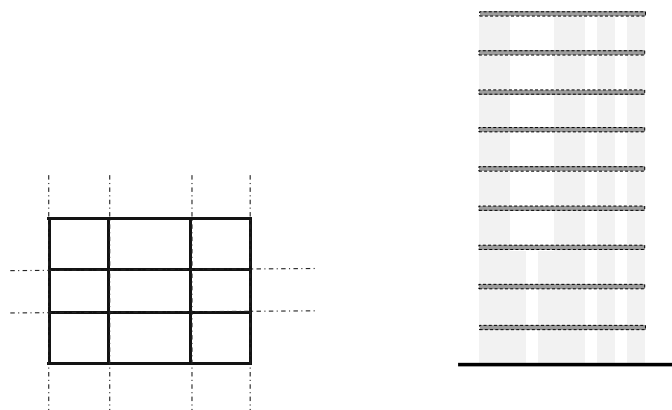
pianta della struttura e vista di una parete con gli elementi strutturali disponibili (strisce verticali di parete)
